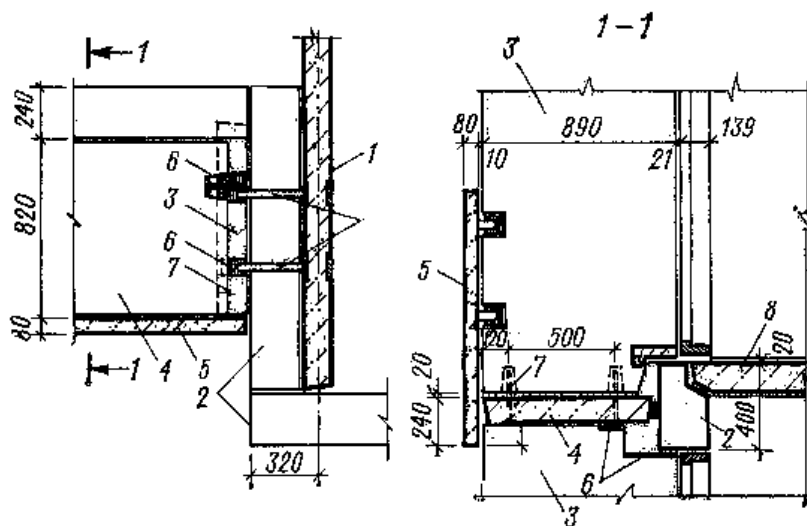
Пример конструктивного решения лоджии крупнопанельного здания с навесными стенами. Конструкция лоджии: 1 – поперечная несущая стена, 2 – навесные панели из ячеистых или легких бетонов, 3 – дополнительная железобетонная стенка лоджии, 4 – плита лоджии, 5 – панель ограждения, 6 – закладные детали, 7 – фиксатор, 8 – панель перекрытия.
